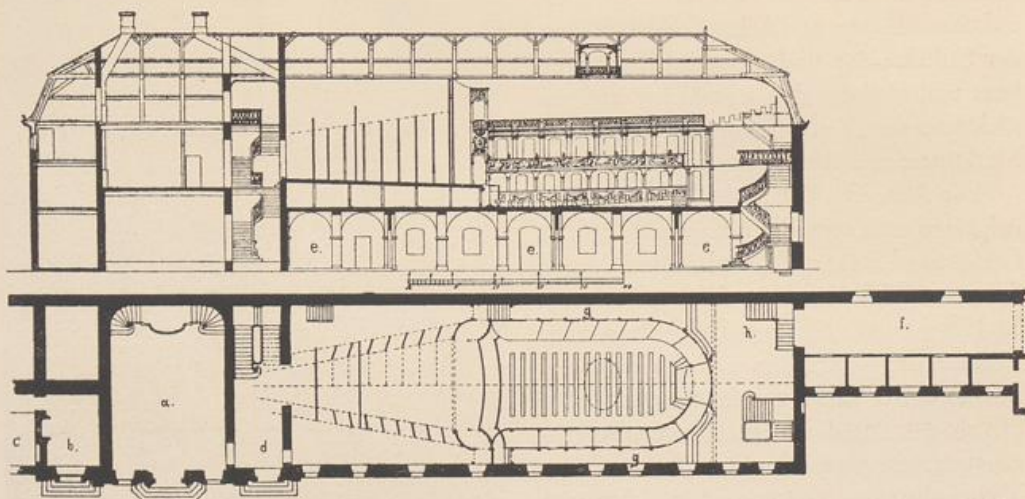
J. J. Couven. Schnitt und Grundriß der ehemaligen „Acht“ und des Theaters auf dem Chorusplatz zu Aachen Vgl. Fassade der „Acht“ Abb. 134.
